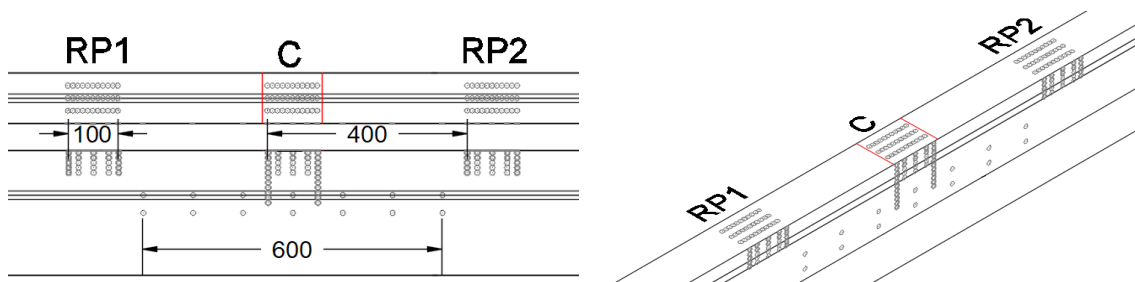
Vista de la instrumentación en planta y alzado (parte izquierda) y vista en 3D (parte derecha). (Fuente: Elaboración propia).
